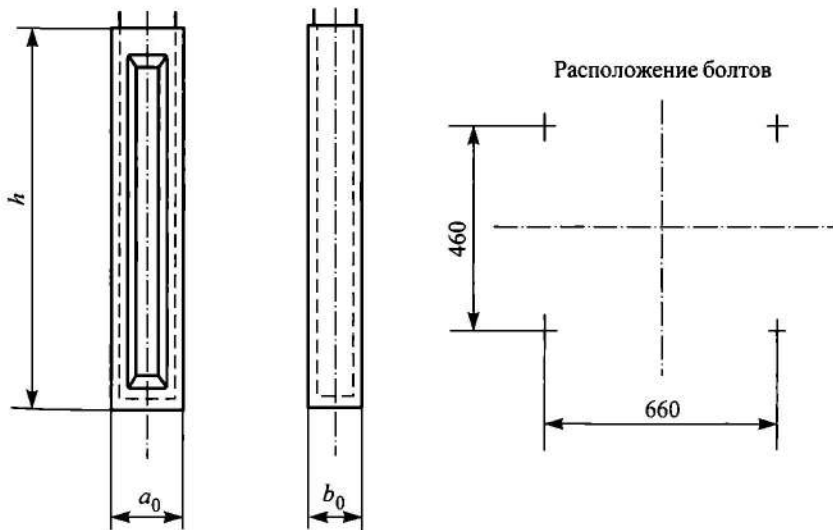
Бетонные фундаменты консольных и фиксирующих опор
